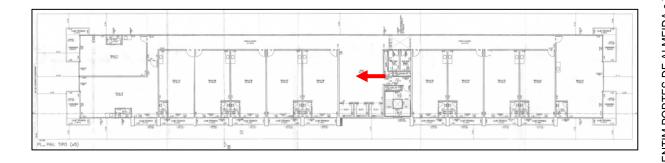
Segundo pavimento. Destaque para trecho da estrutura degradada pela exposição às intempéries.
